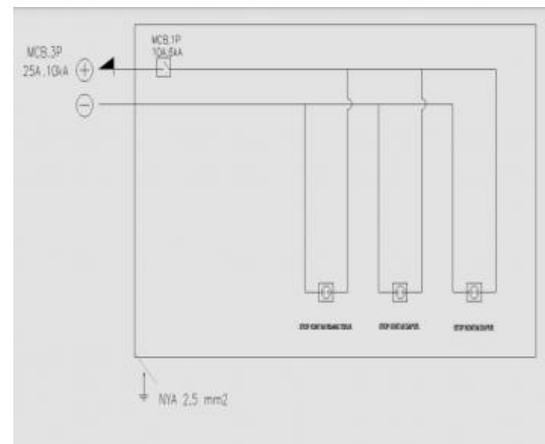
Rangkaian instalasi lampu lantai 3
